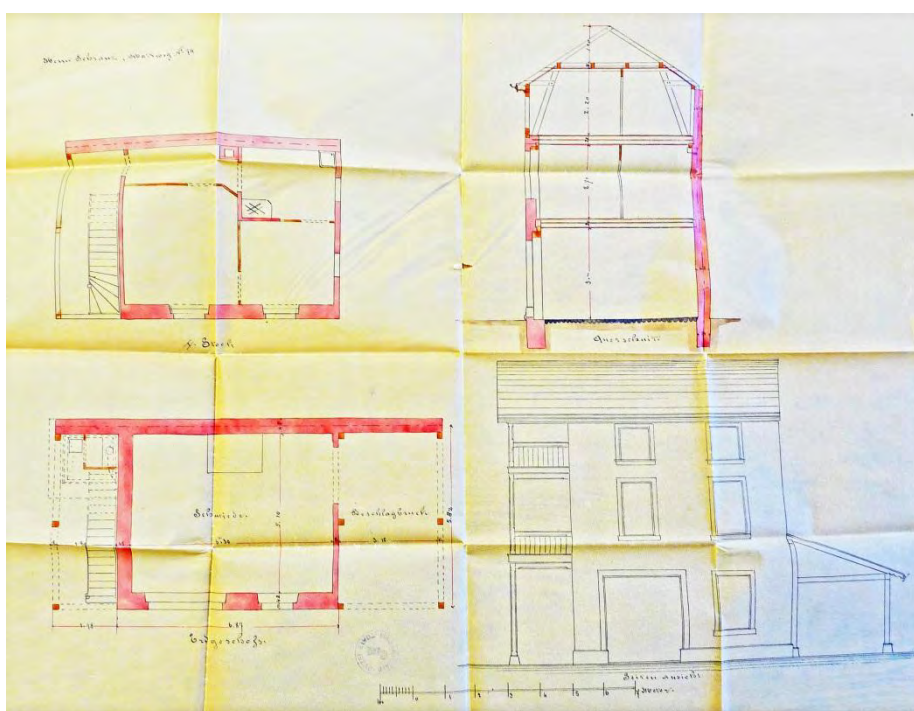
Grundrisse (Erdgeschoss und 1. Stock), Schnitt, Seitenansicht
